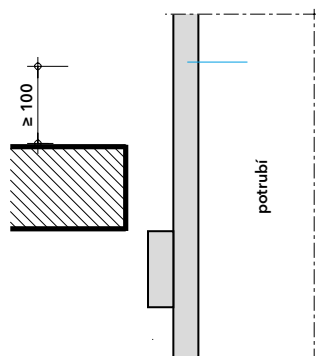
Detail A – příčný řez ventilačním kanálem, základní a velký rozměr
